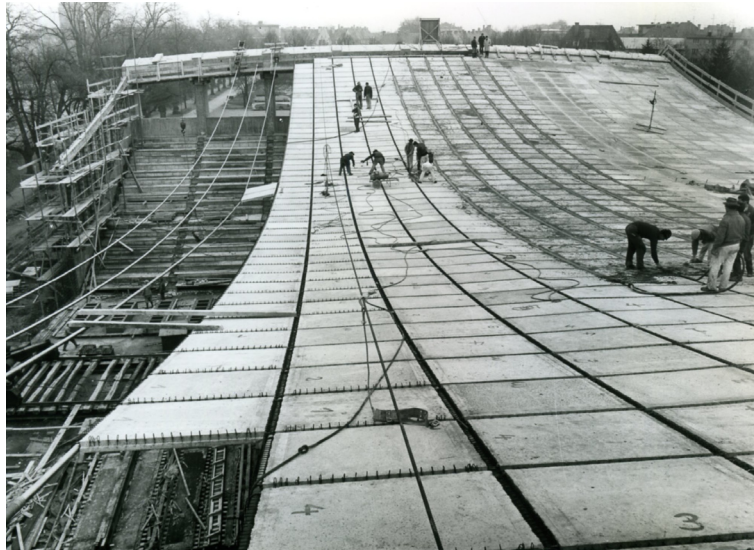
Dachfläche während des Eindeckens mit Fertigteil-Elementen auf Spanngliedern des Typs BBRV-85, Sporthalle Augsburg, Architekt: Hugo Gall (BNr. 37) [Bild-Archiv des Instituts für Tragwerksplanung, TU Braunschweig]
